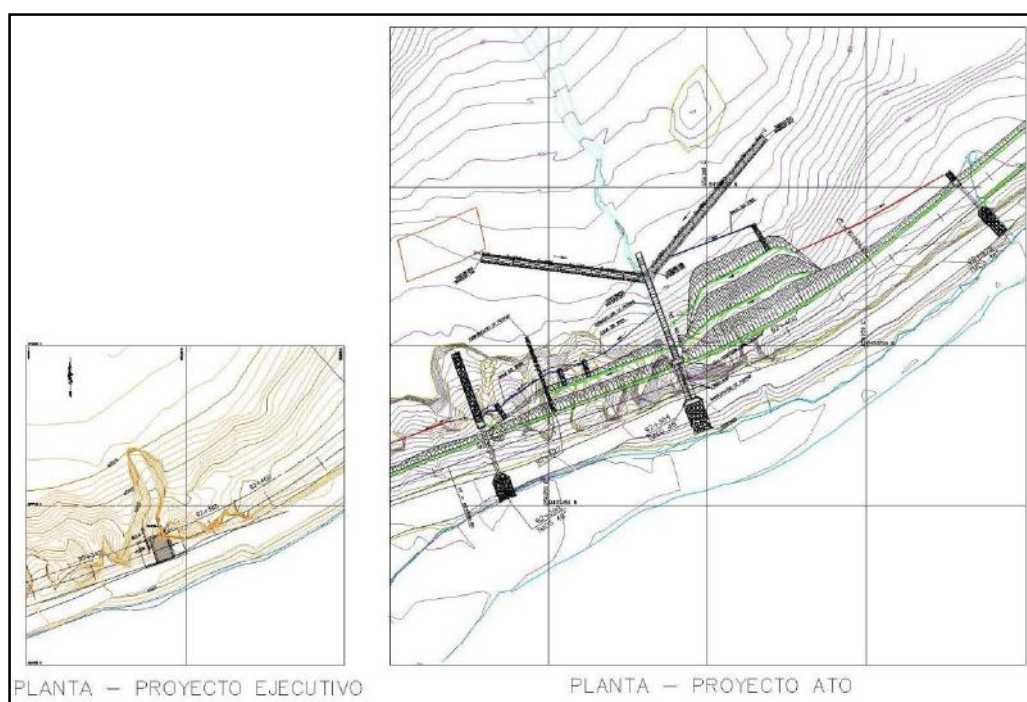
Drenagem - Planta Projeto Executivo e Projeto ATO.
